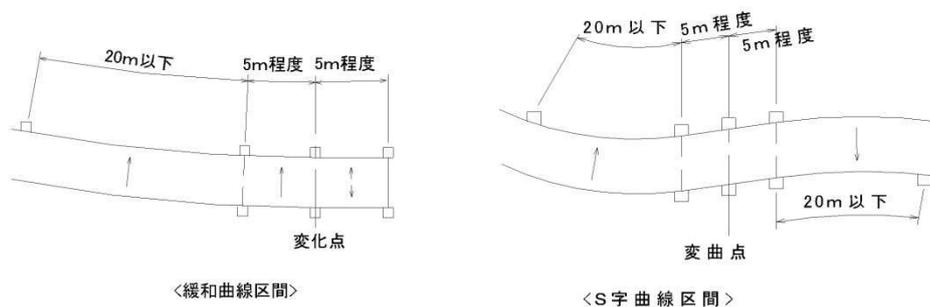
変曲点付近の排水樹の設置方法（平面図）
